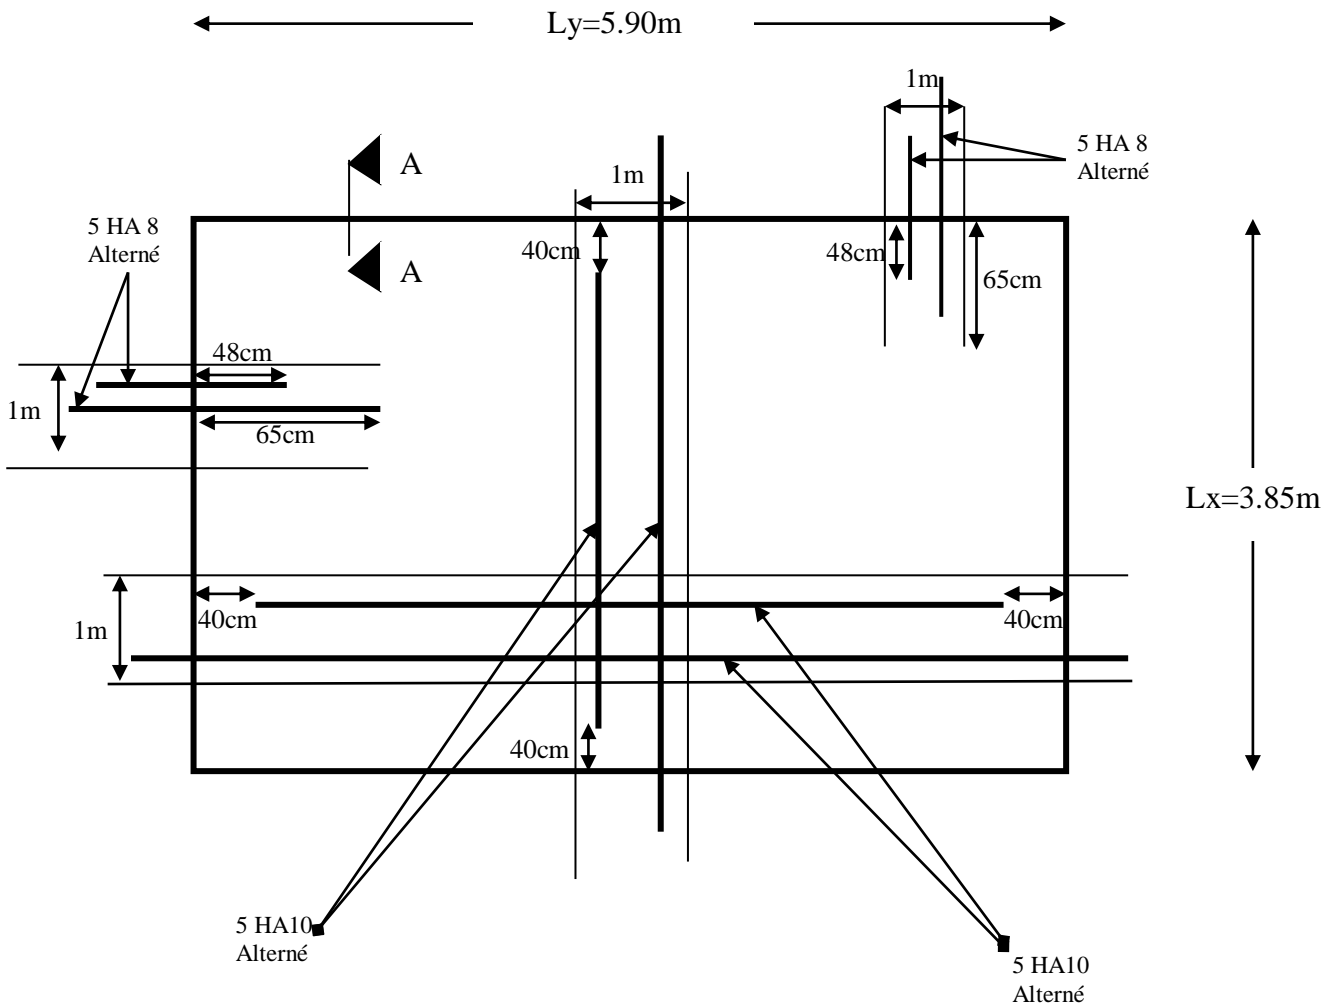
Schéma de Ferrailages de la dalle pleine
